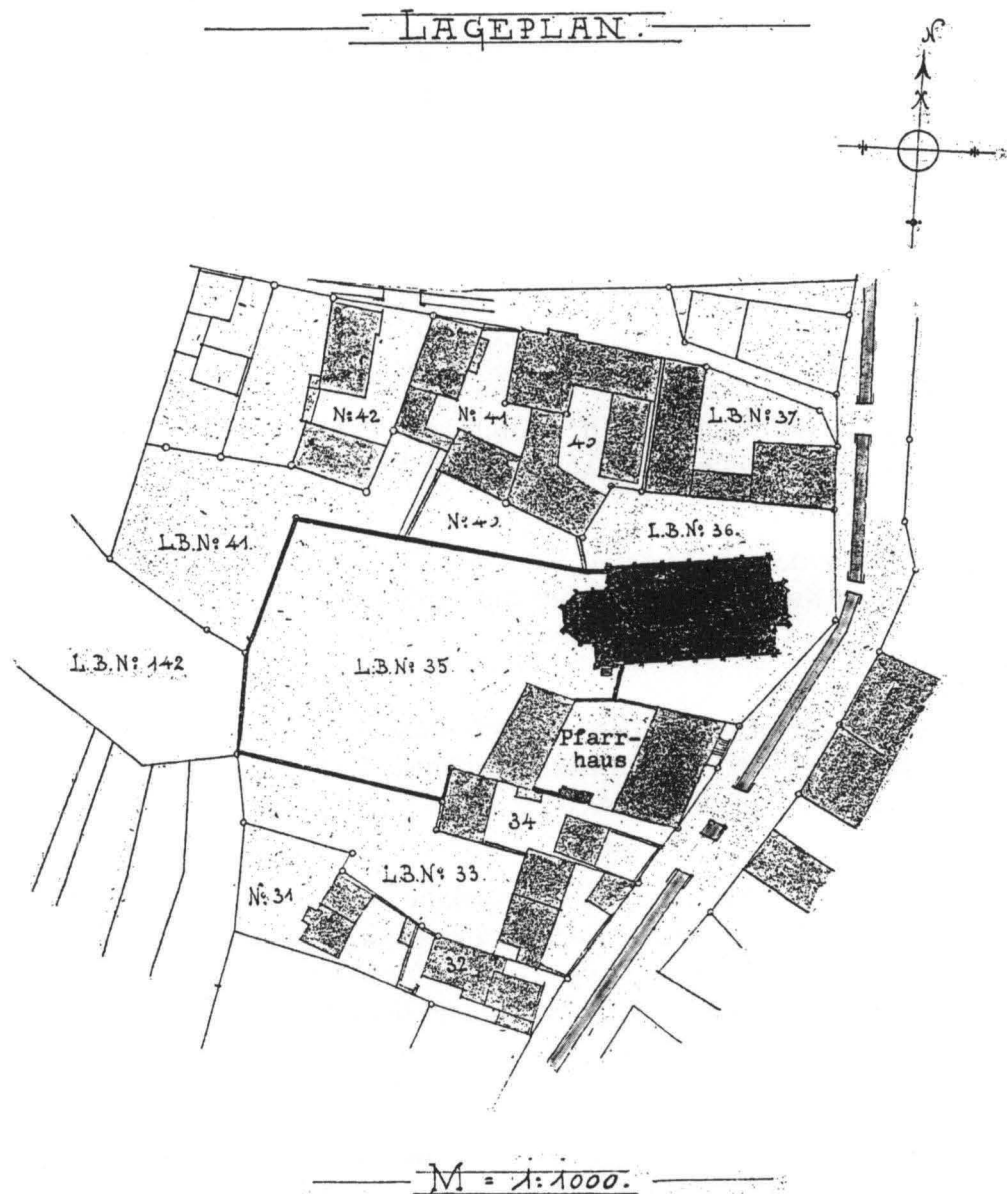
Lageplan von Kirche und Pfarrhaus in Köndringen, 1901
